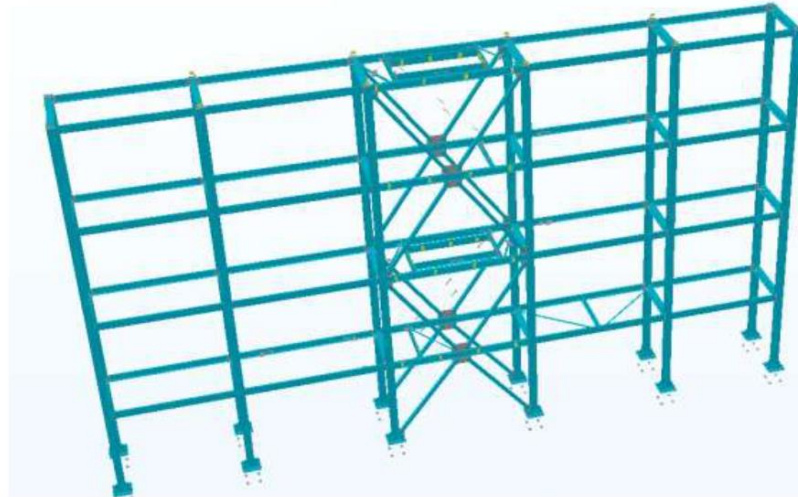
SECUENCIA MONTAJE DE VIGAS DE AMARRE ENTRE PORTICOS
